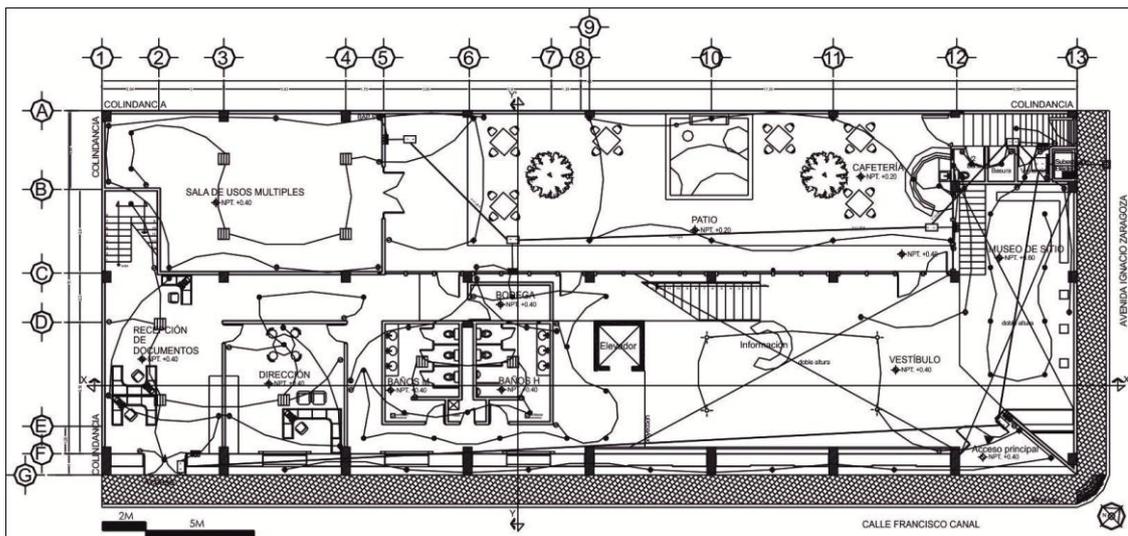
Plano de instalaciones eléctricas de planta baja.
